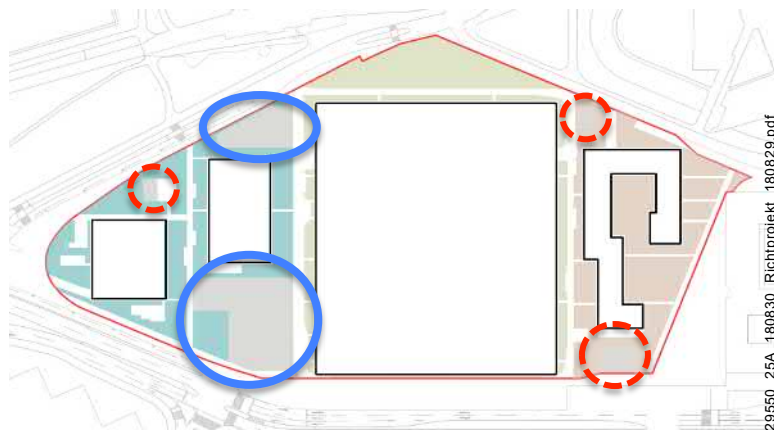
Freiflächen im Veranstaltungsbetrieb mit Kennzeichnung der temporären Abstellflächen (grau dargestellt):
